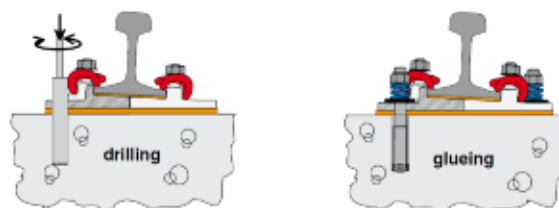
Aplicação de fixação EDF sobre a laje ou longarina [6]
